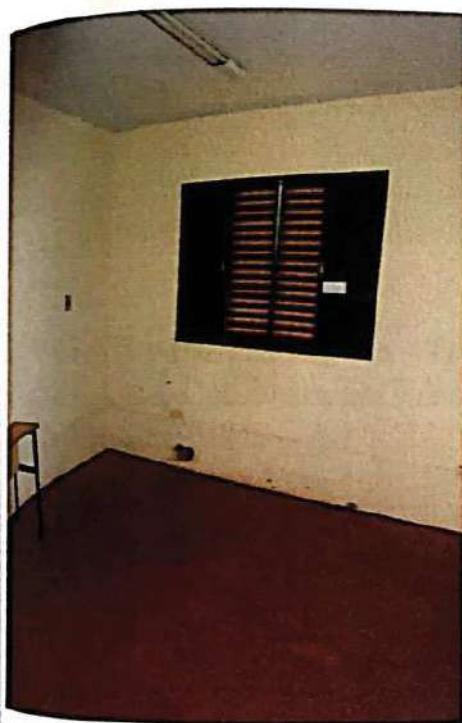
e 49 - 01^a Residência - Dormitórios. Laje e Piso e Cimento Queimado.
